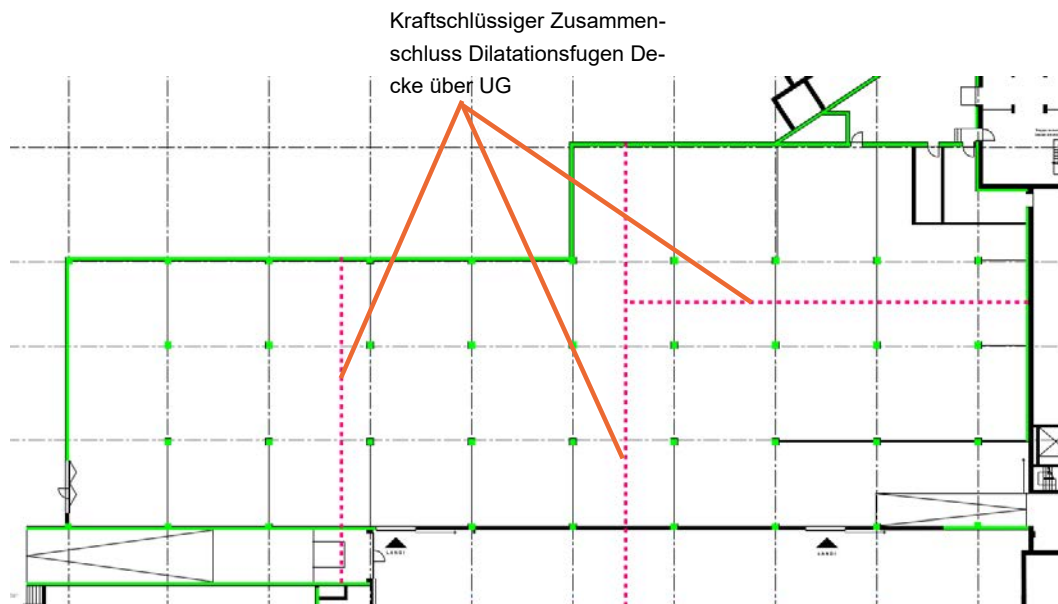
Grundriss UG Lagerhalle: mögliche Massnahmen am Tragwerk
